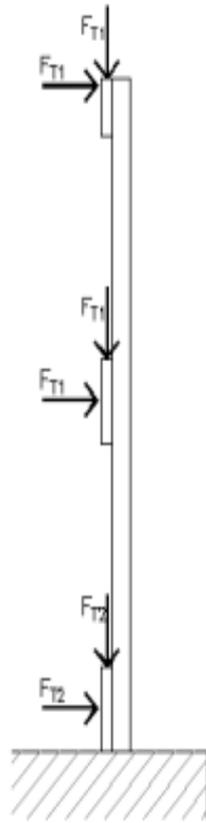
Cargas de serviço – Alternativa 1, cargas atuando separadamente
